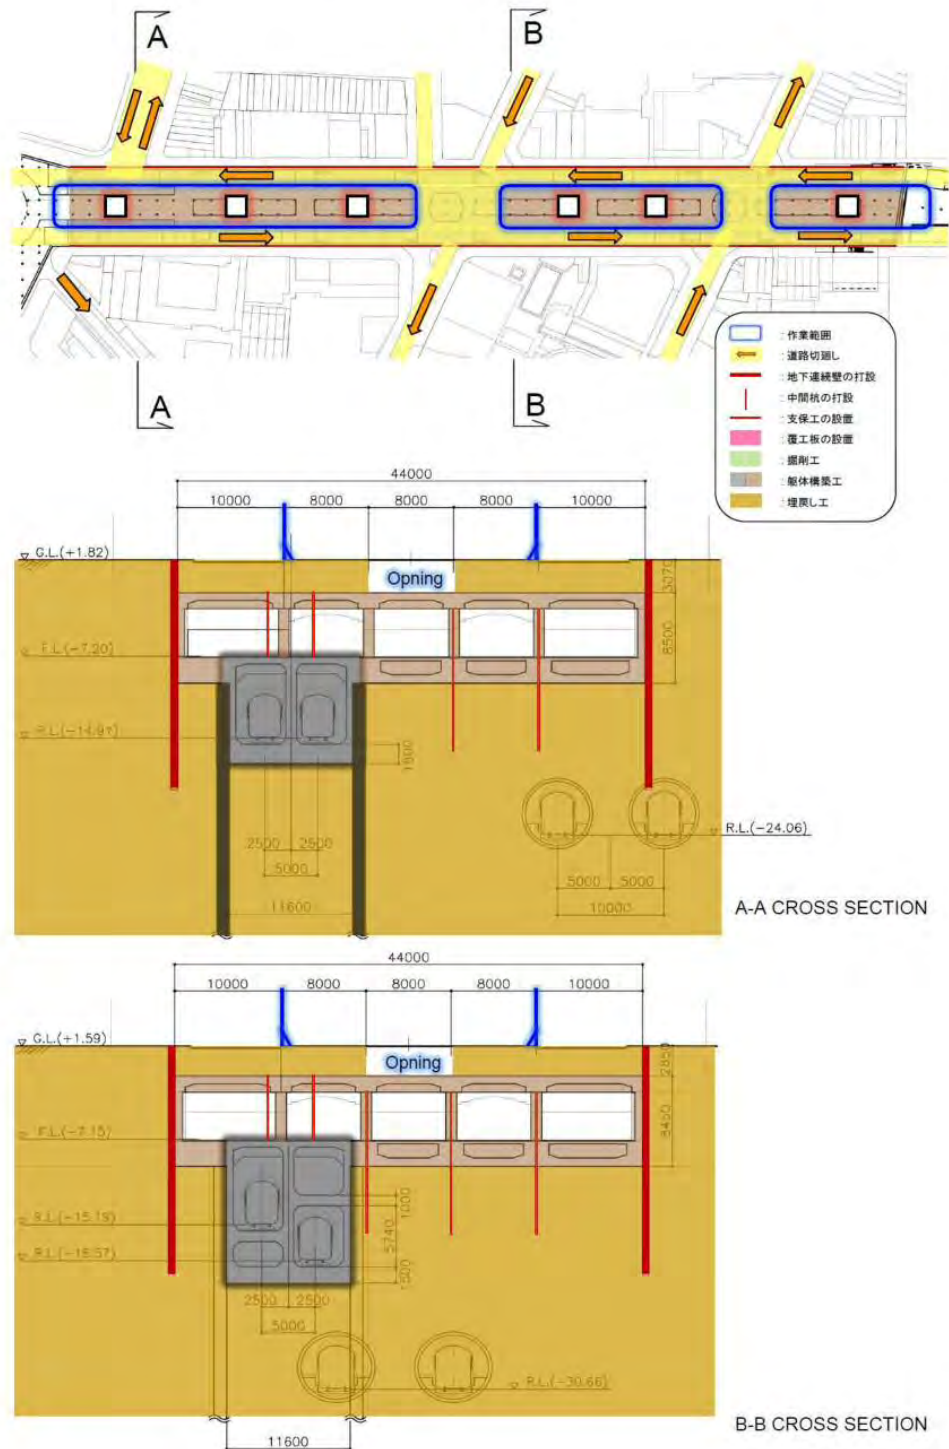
レロイ通り地区の都市鉄道 1 号線と地下街の施工手順図 (その 13/14)
